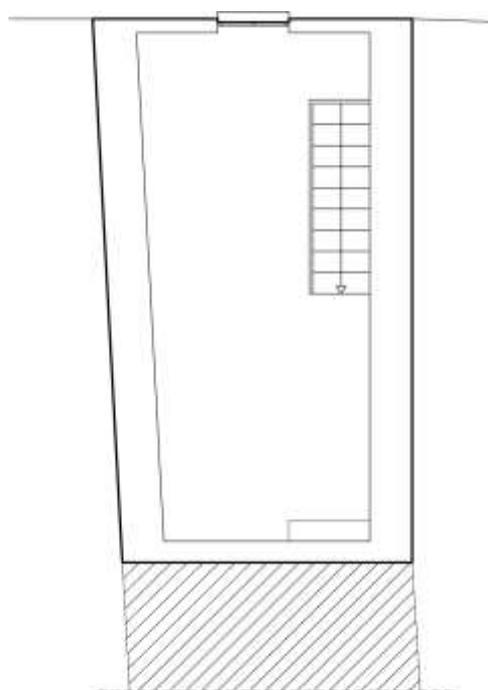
Planta do Piso 0 de uma casa com divisão e saguão. (Ilustração nossa, 2021)
